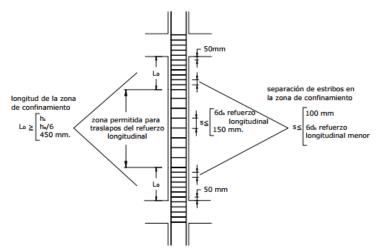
Separación de Estribos Fuente: (NEC, 2015)
